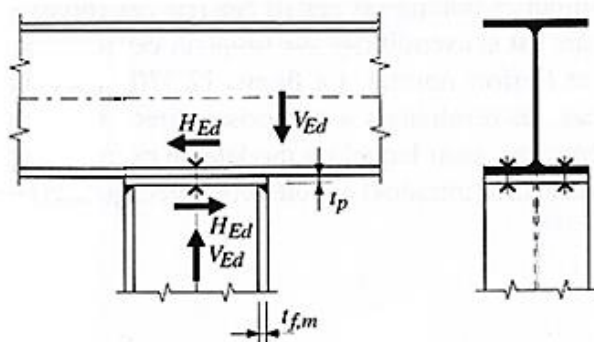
Algumas indicações de dimensionamento para uma ligação viga-pilar articulada: viga colocada sobre o pilar, empregando parafusos pré-esforçados e chapa de testa estendida (Hirt, M.A.; Crisinel, M., 2005)
